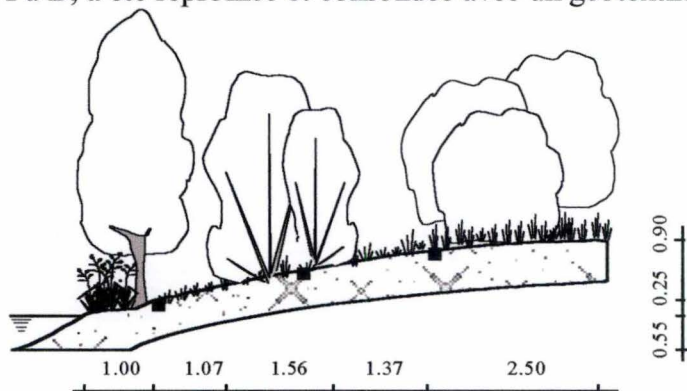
Profil de berge de la station plantée de Furfooz B
